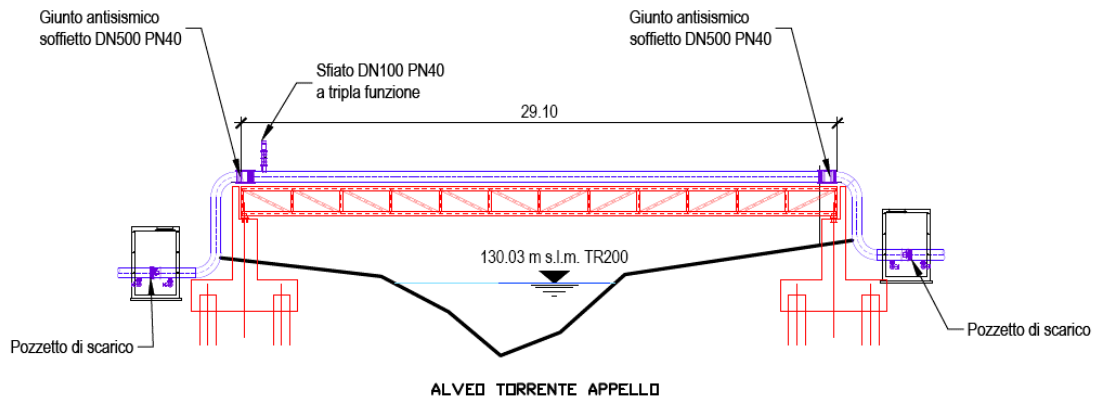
Sezione longitudinale attraversamento aereo di progetto sul Fiume Appello.
